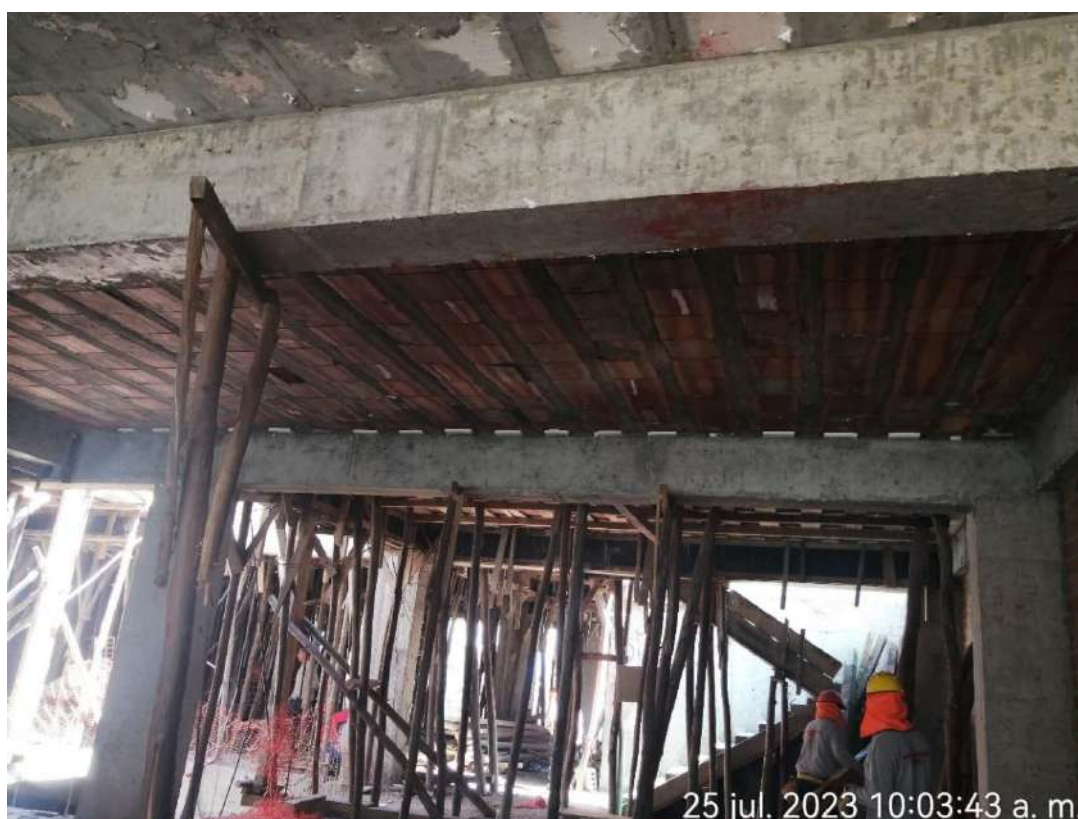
Desencofrado en vigas y losa del 3er nivel
